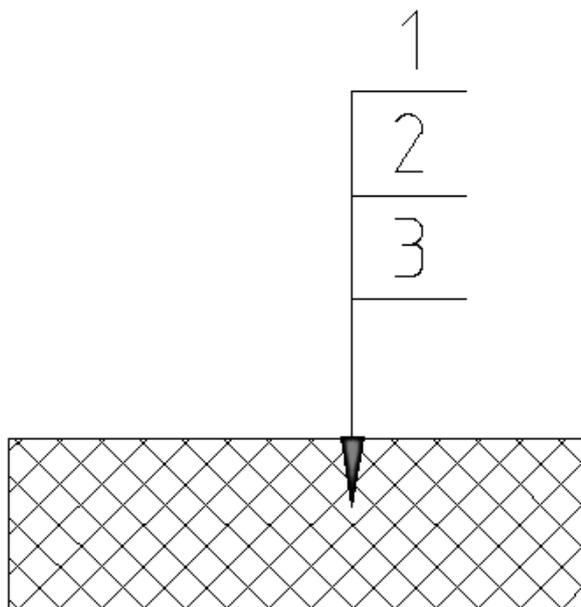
Расчётная схема бесчердачного перекрытия
